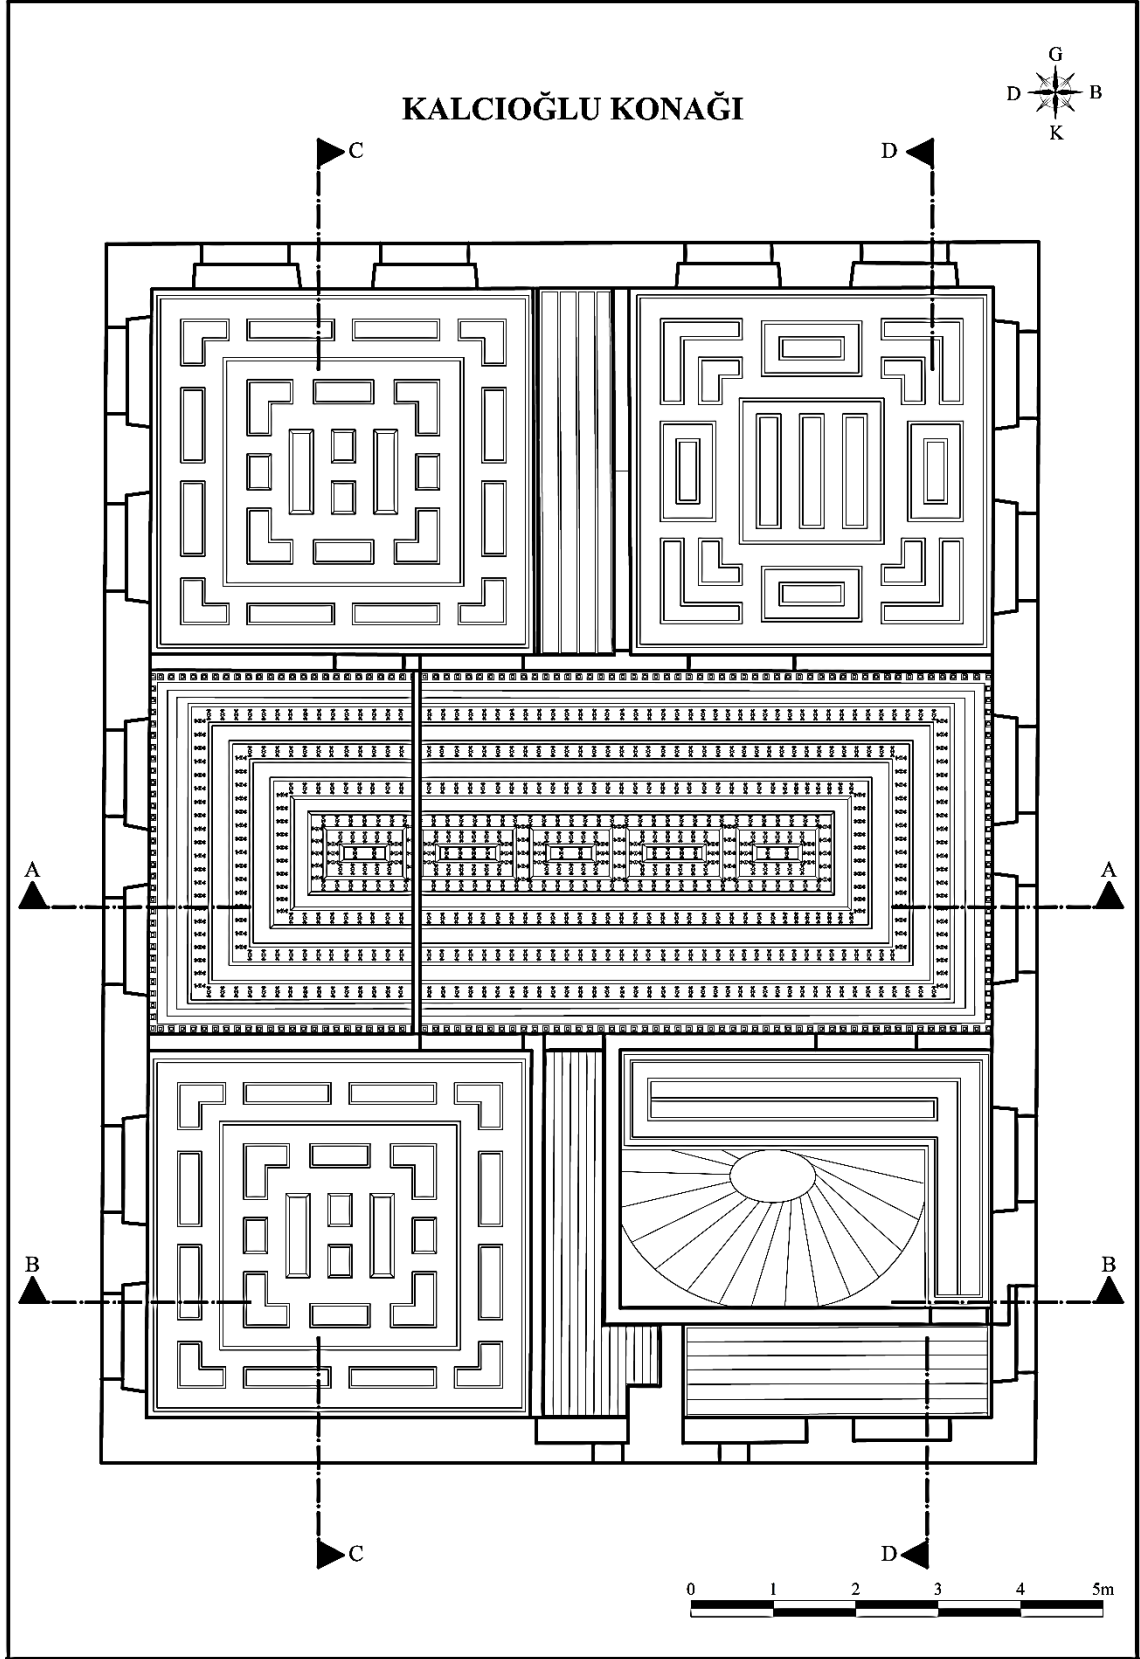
Rölöve- Çatı Planı (Turhan, 2013)
